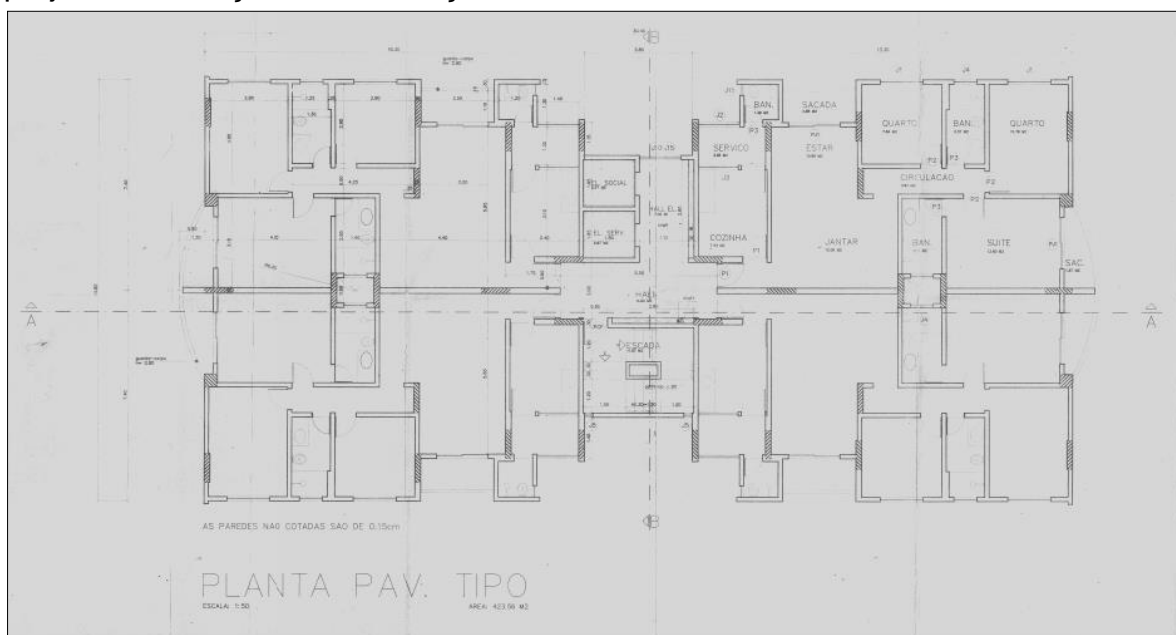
Planta baixa do edifício. (Fonte: Arquivo pessoal).
